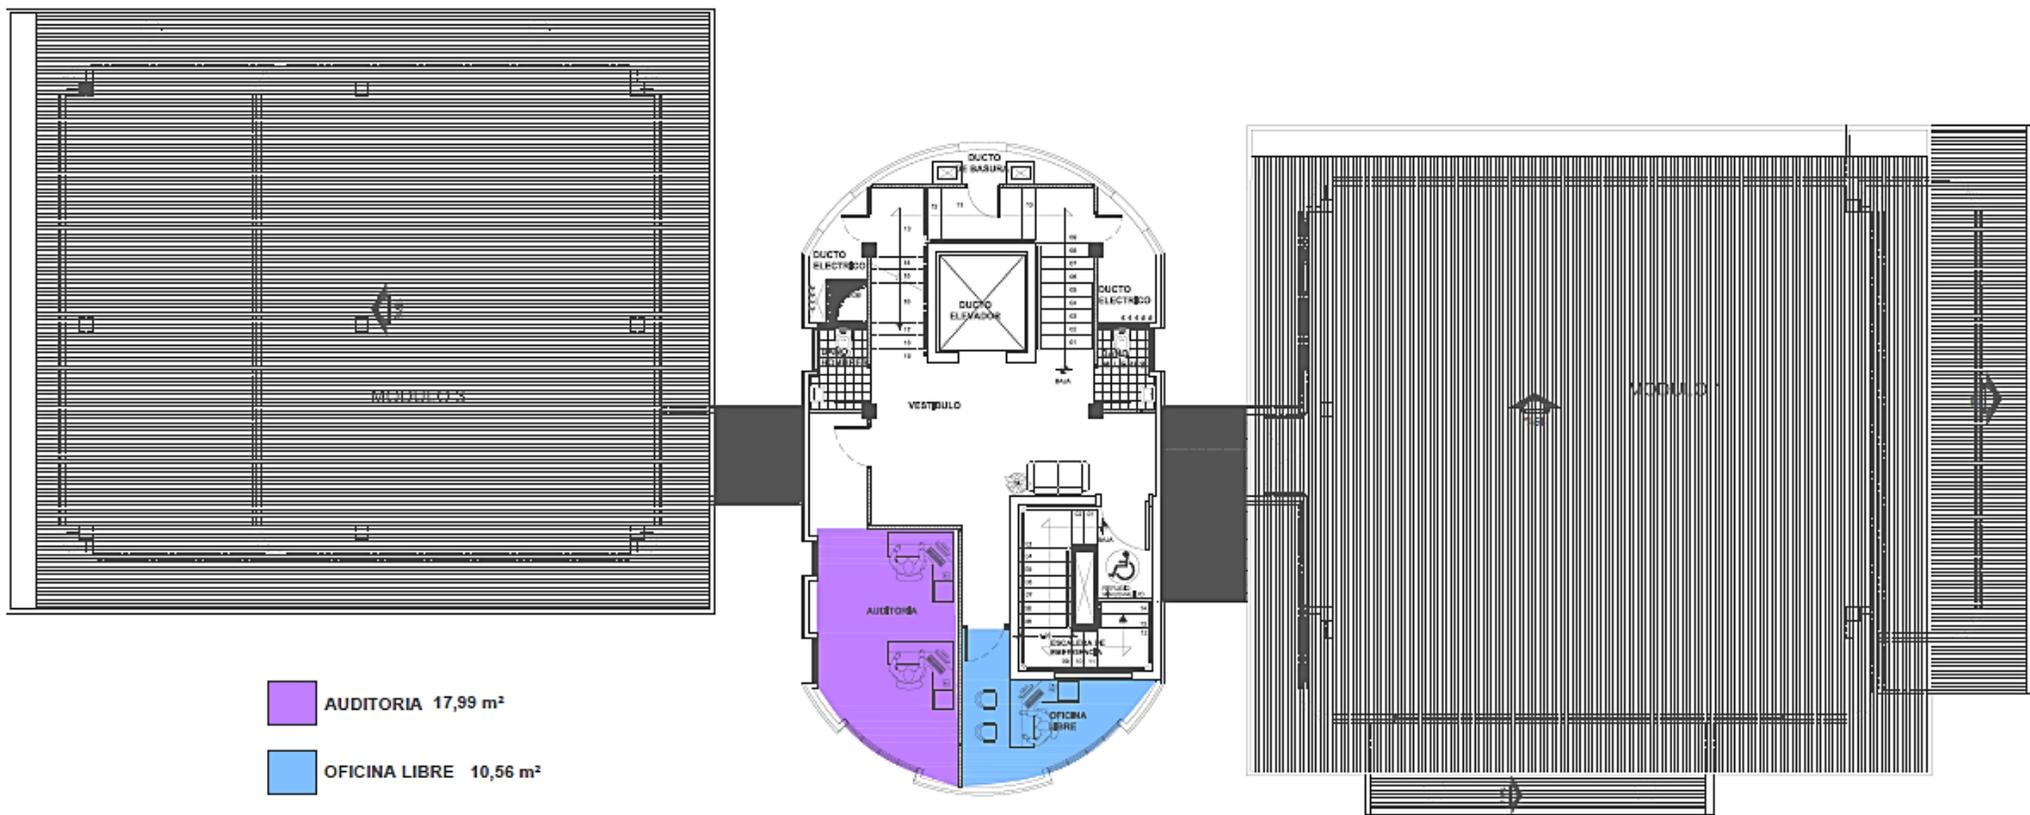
Distribución de oficinas en planta arquitectónica, nivel 04
